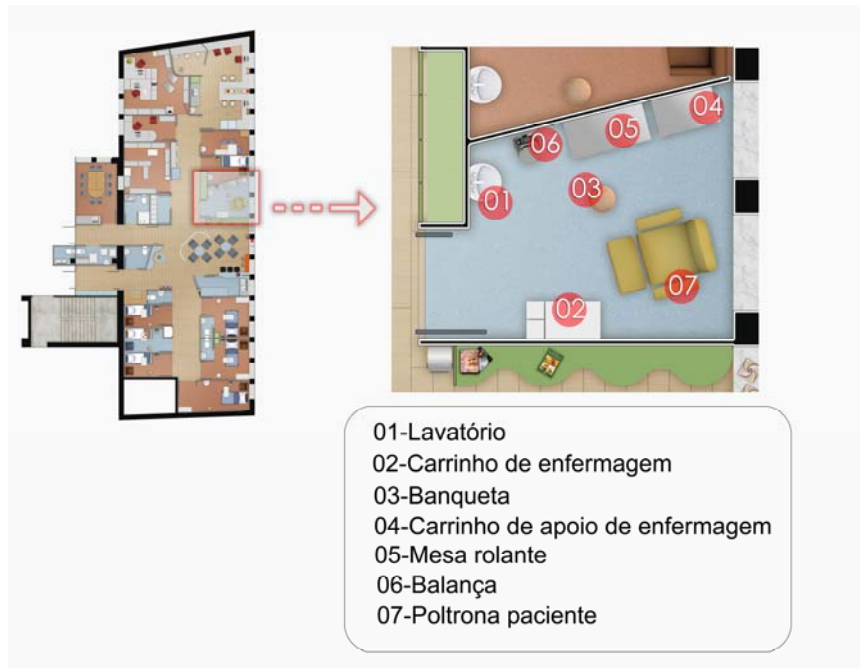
Planta de implantação e leiaute do boxe 7 – hospital-dia VIH posterior ao projeto
